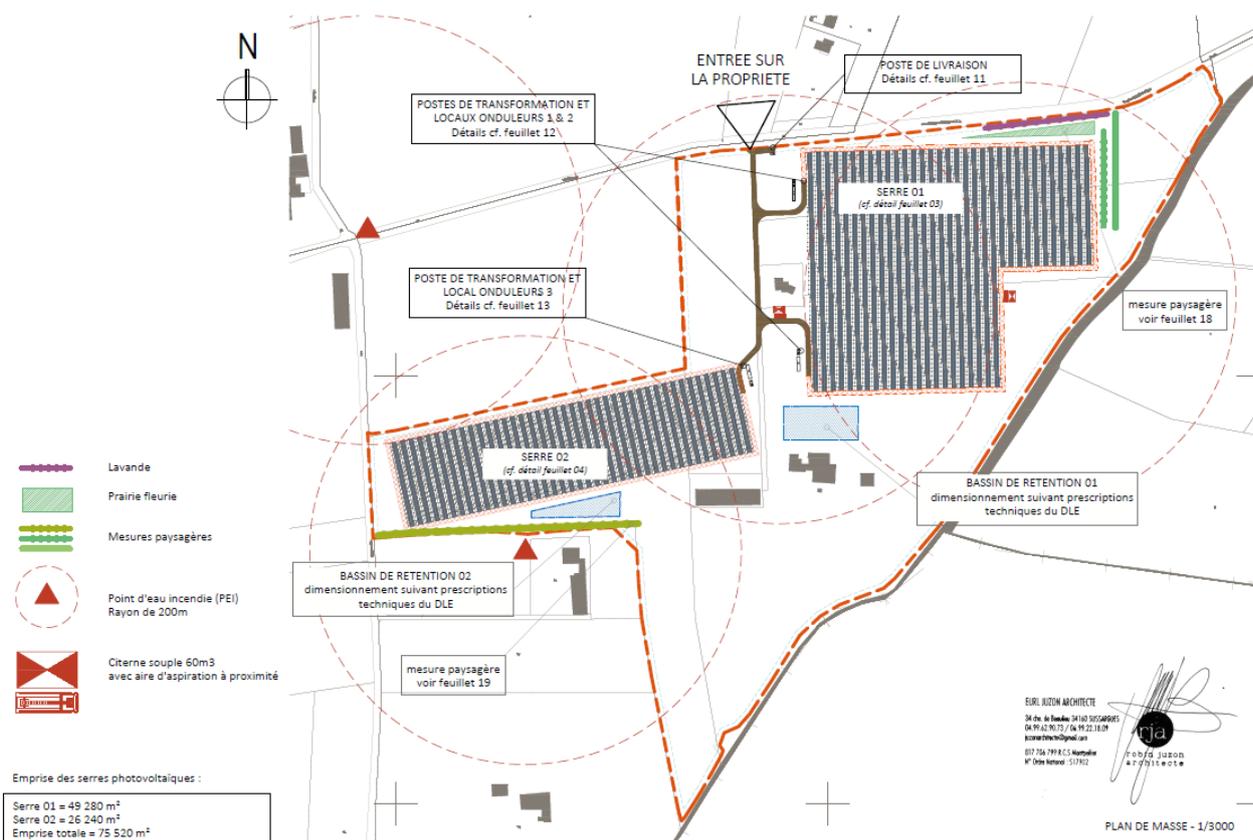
Plan de masse du projet (source : dossier permis de construire – Eurl Juzon architecte)
